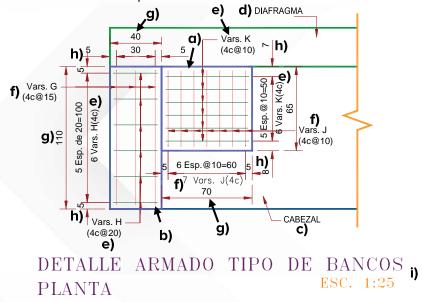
Ejemplo de planta de detalle armado tipo de bancos
